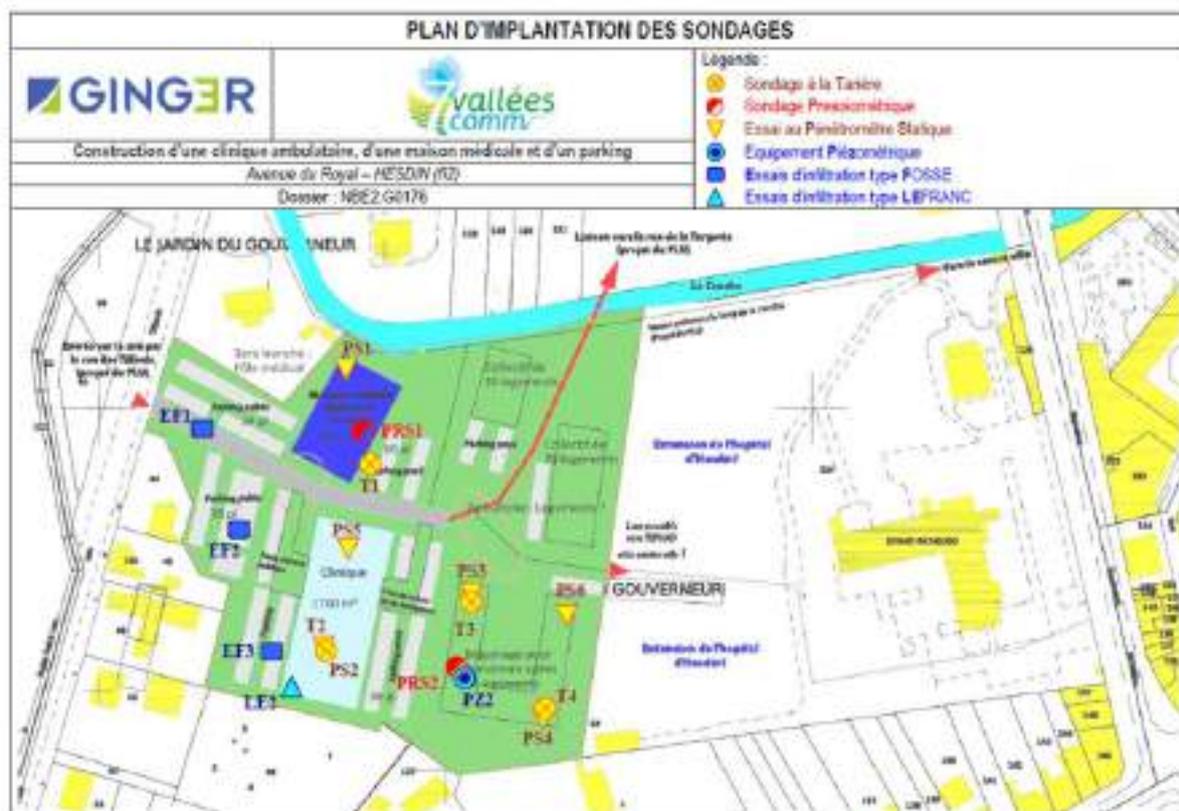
Plan d'implantation des essais géotechniques réalisés par le bureau d'étude GINGER
